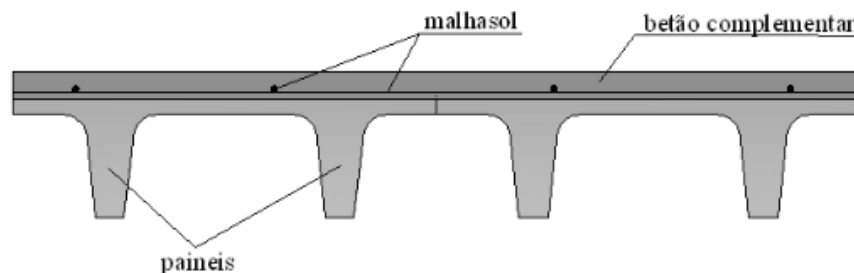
Pormenor de ligação de 2 lajes TT [5]
